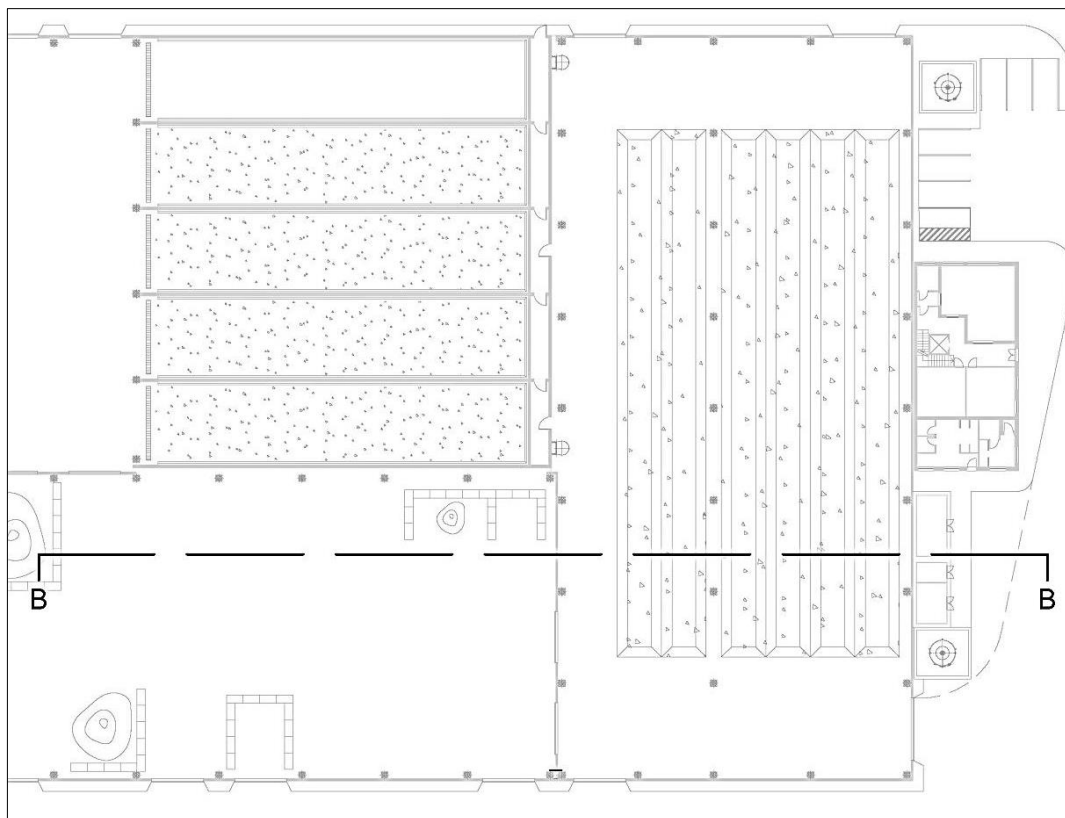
PIANTA MATURAZIONE SECONDARIA
